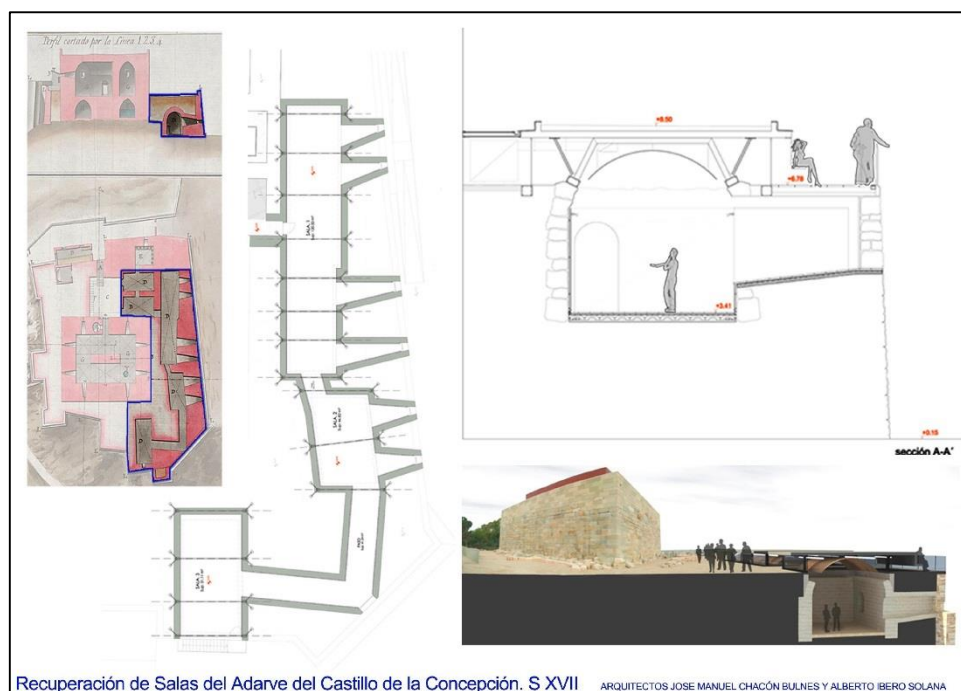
Planos de alzado, planta y sección del proyecto de recuperación de las salas
